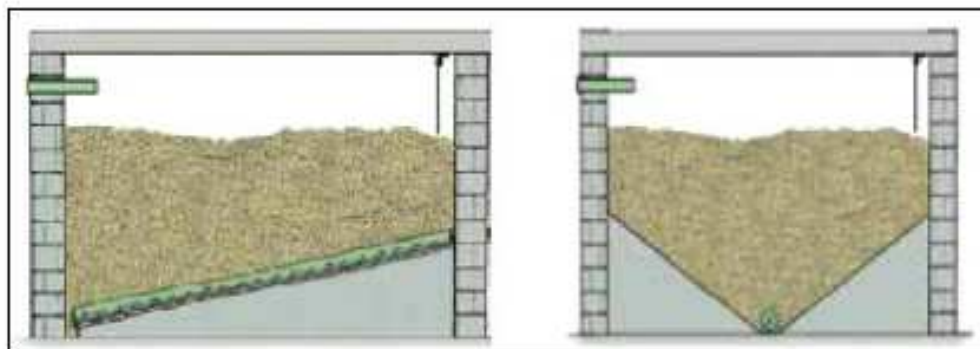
Silos construídos em alvenaria ou estrutura metálica com fundo em V e extrator de parafuso sem-fim [9]
